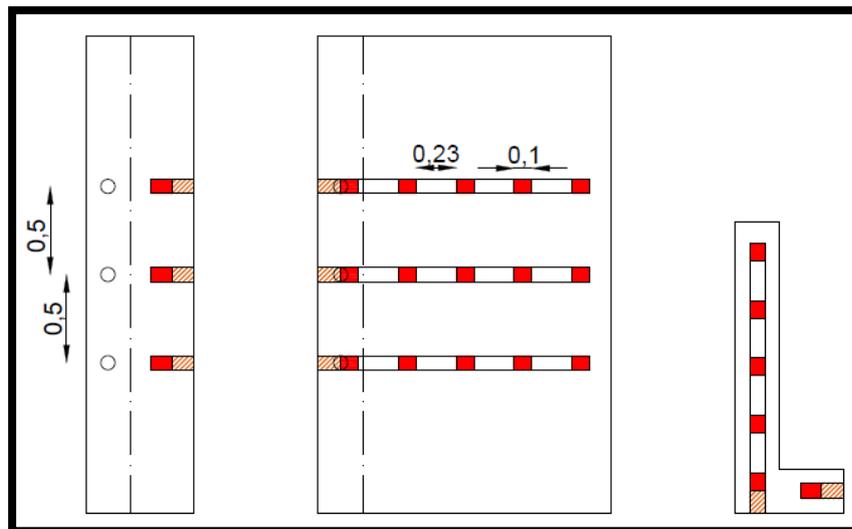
Alzado, perfil y planta del pilar “Hueco del Ascensor” de la Planta baja.
